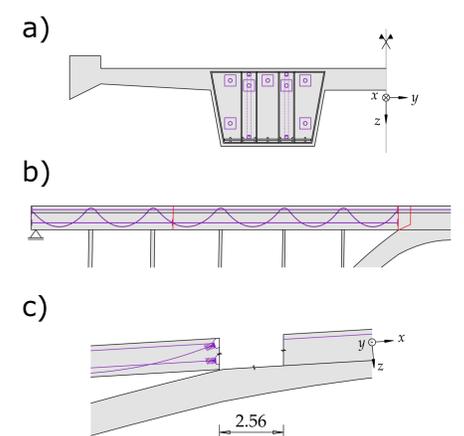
Entwurfsergebnis der Bogenbrücke: a) Grundriss, b) Ansicht und c) Schnitt A-A.
